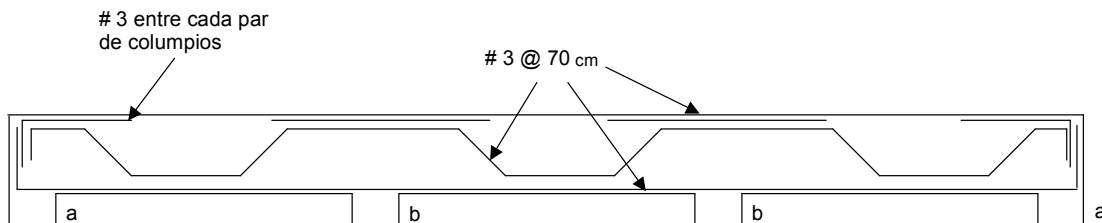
Croquis de armado de losa del edificio de 12 niveles
